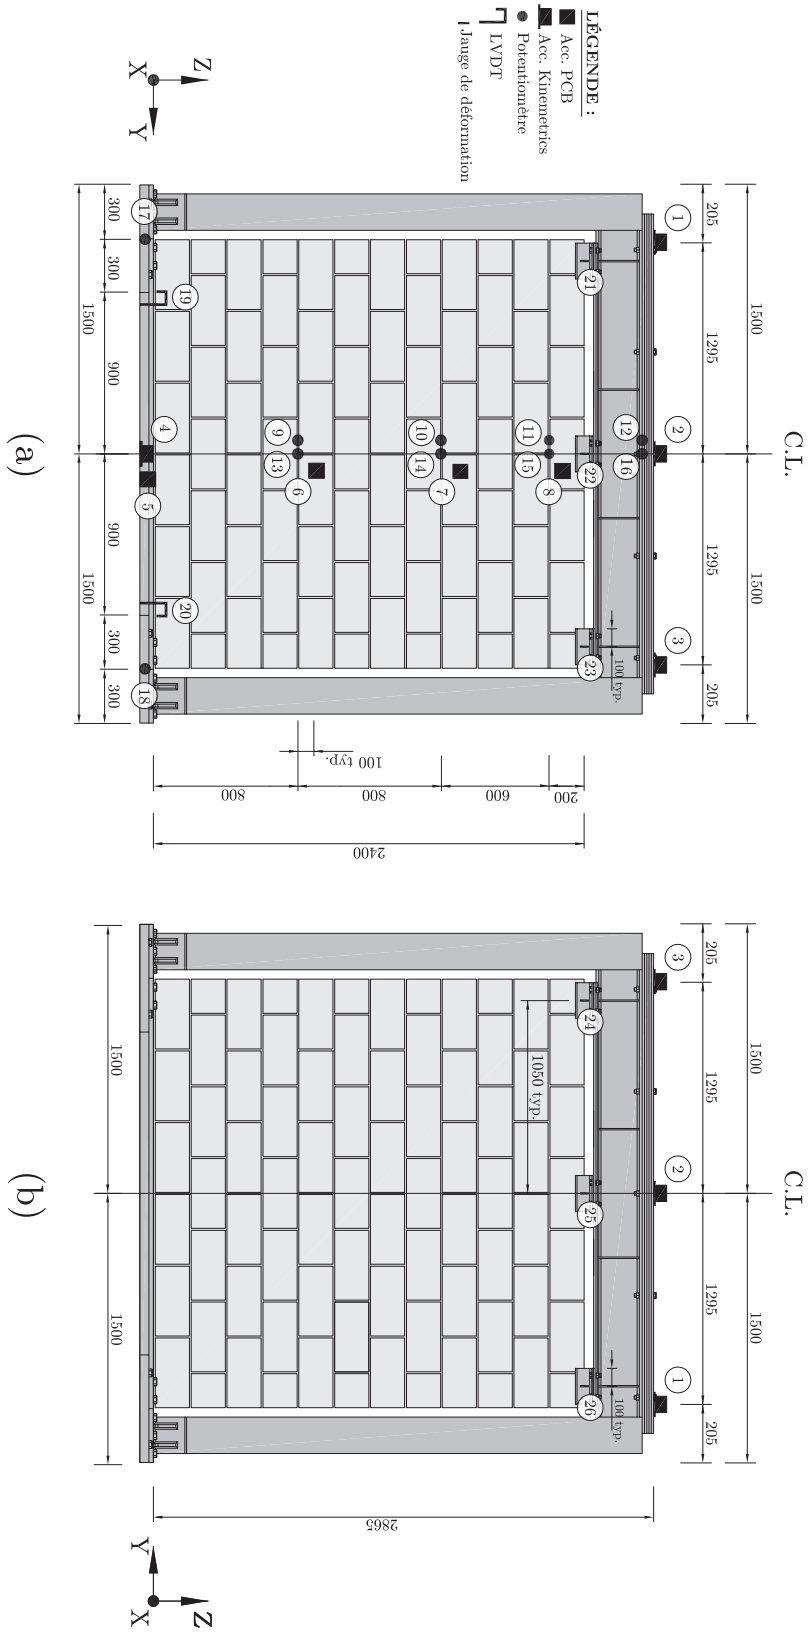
Plan de l'instrumentation du 2<sup>e</sup> mur (a) façade avant du mur (b) façade arrière du mur
